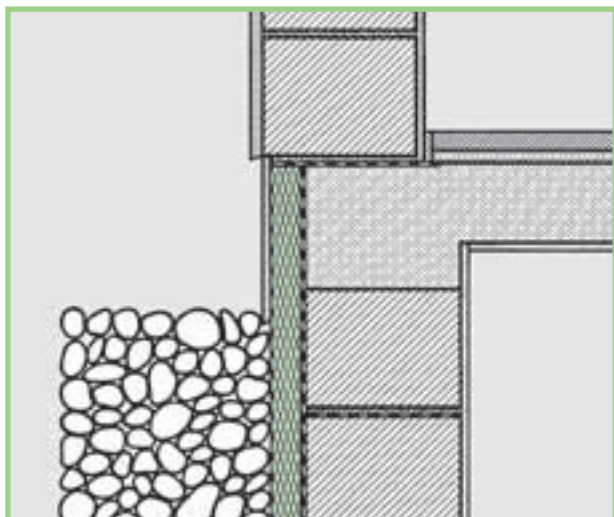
Zona dello zoccolo, isolamento perimetrale con parete isolata termicamente.
